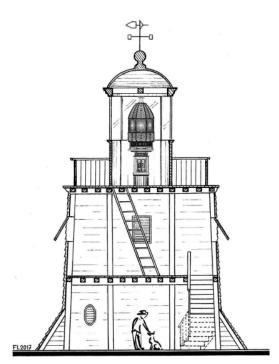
Recreación en sección transversal, del segundo faro de la isla de Santa Clara (dibujo de los autores 2017)
